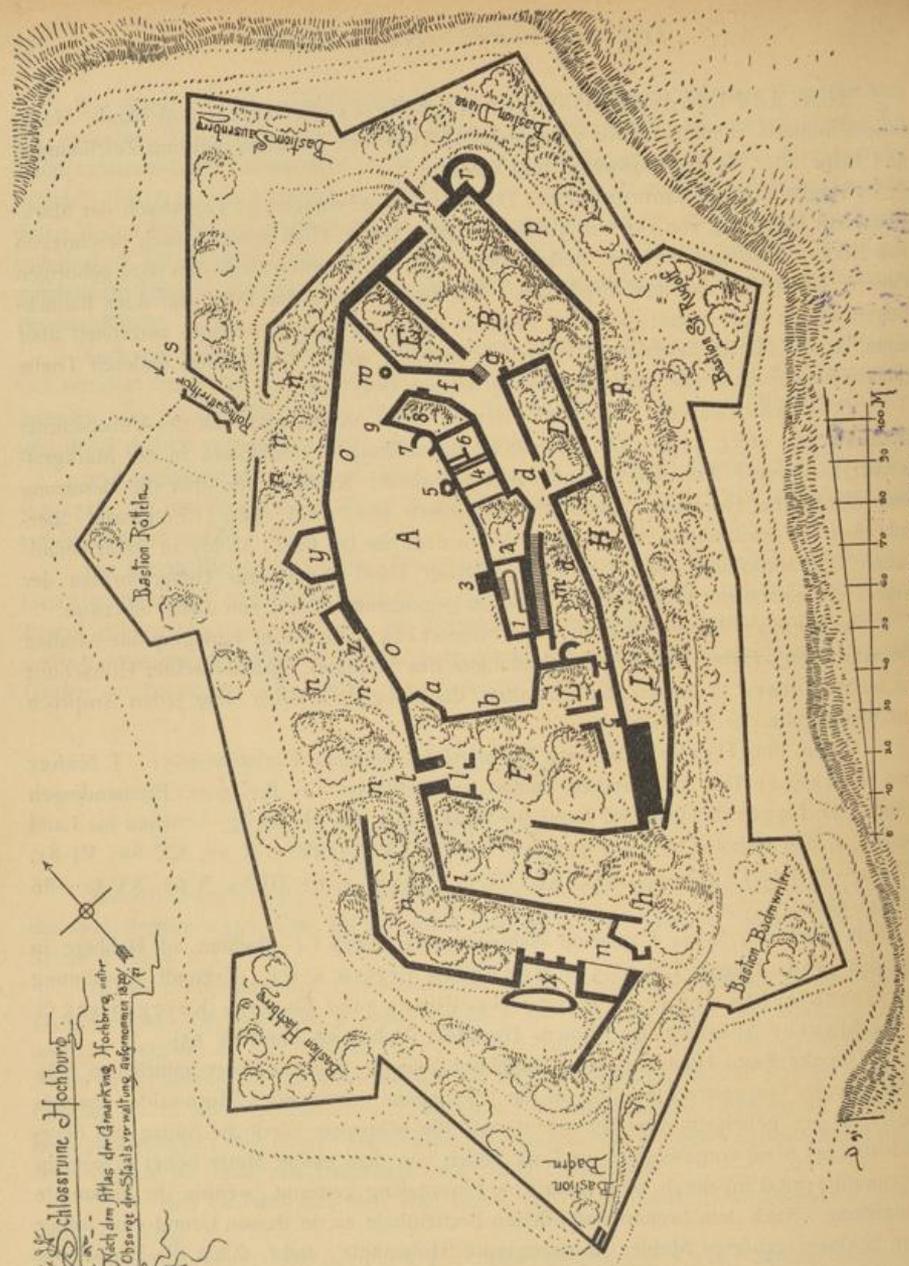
Hochburg. Grundriss des Schlosses.
